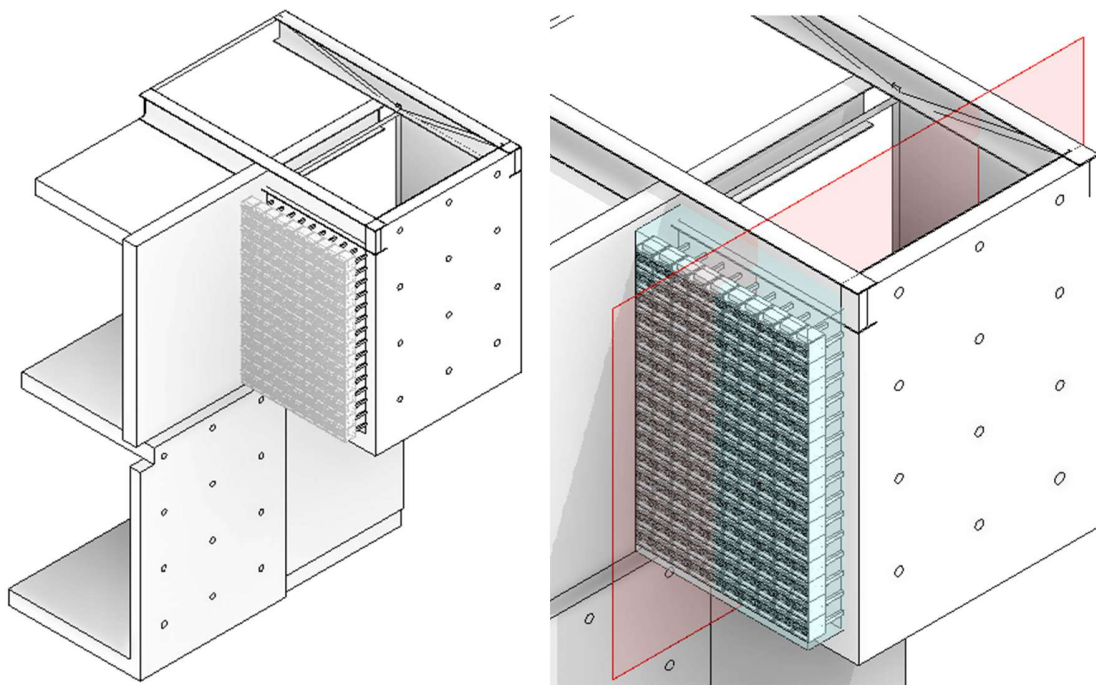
Simulación de fachada con elemento prefabricado arquitectónico integrado (Modelo 3D Revit Ecovilla)
